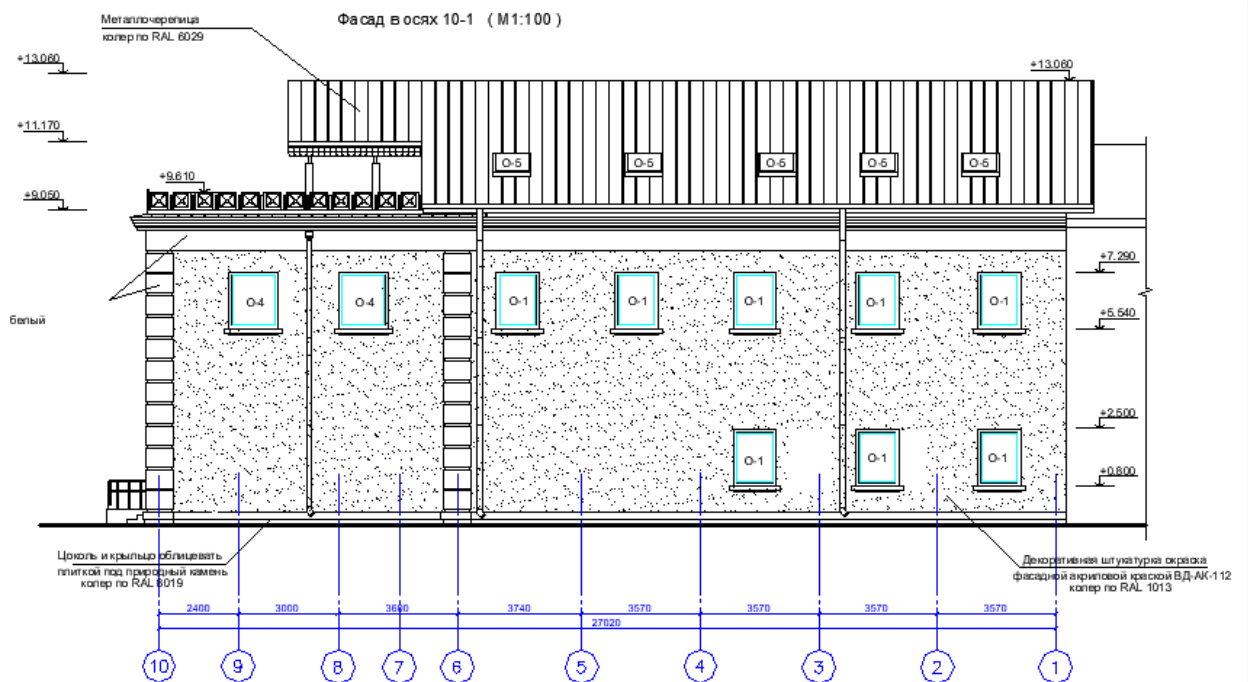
Фасад здания после реконструкции в осях 10-1
